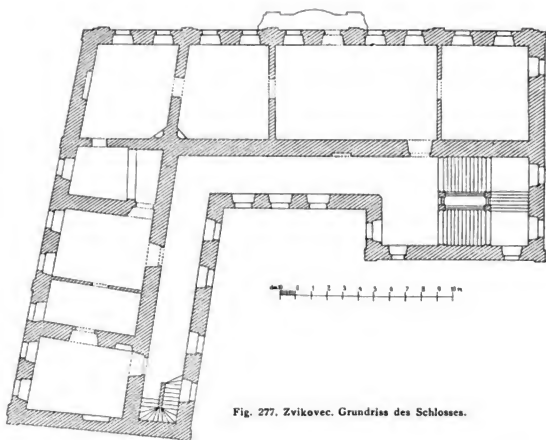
Zvíkovec. Grundriss des Schlosses.
